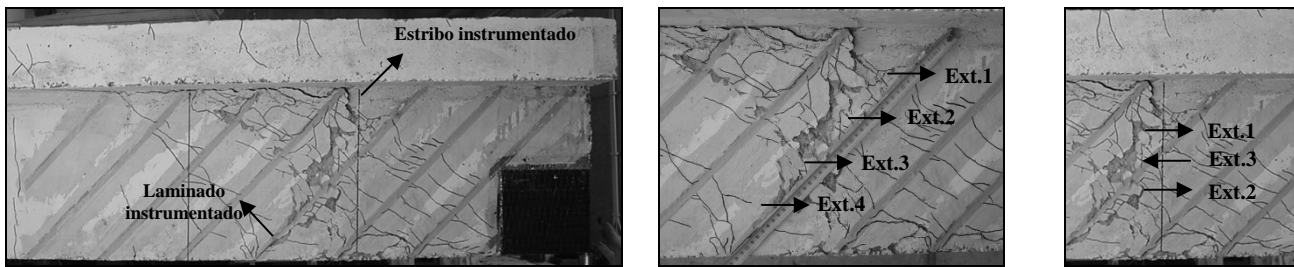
Localização dos extensómetros no laminado e estribo instrumentados da viga 2S-8LI45-A.
